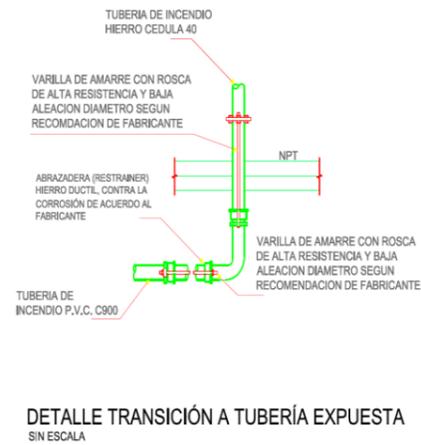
Detalles típicos a considerar para la distribución de tuberías para la instalación de hidrantes. (Fuente: Elaboración propia en AutoCAD 2014)
